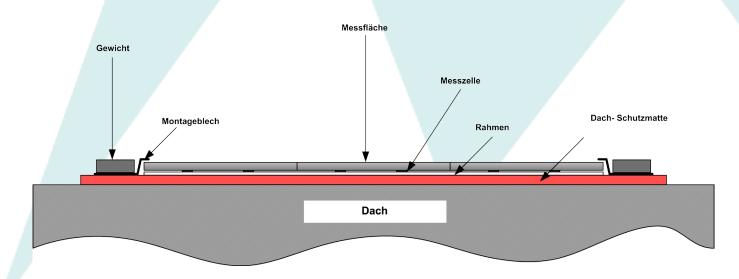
Mögliche Variante zur Montage der Schneewaage SSR auf Flachdach
